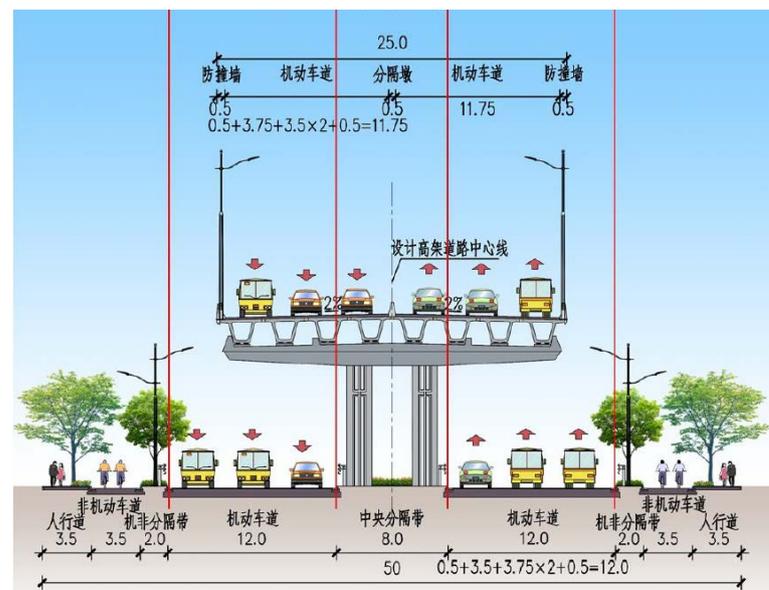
标准横断面布置——三环东路段高架快速路标准横断面图
